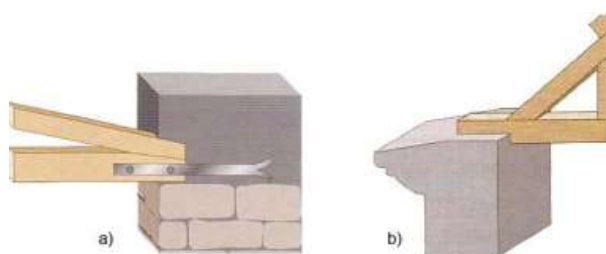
Tipos de apoios de estruturas da cobertura: a) Fixação por elementos metálicos; b) Apoio direto sobre consola de pedra (Pereira, 2013).
